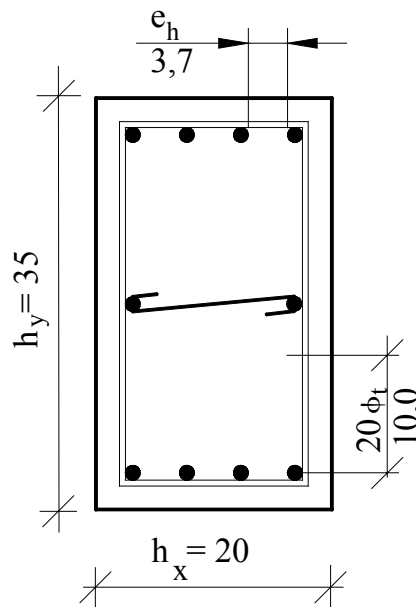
Detalhamento da armadura na seção transversal para 10 ϕ 10 mm.
